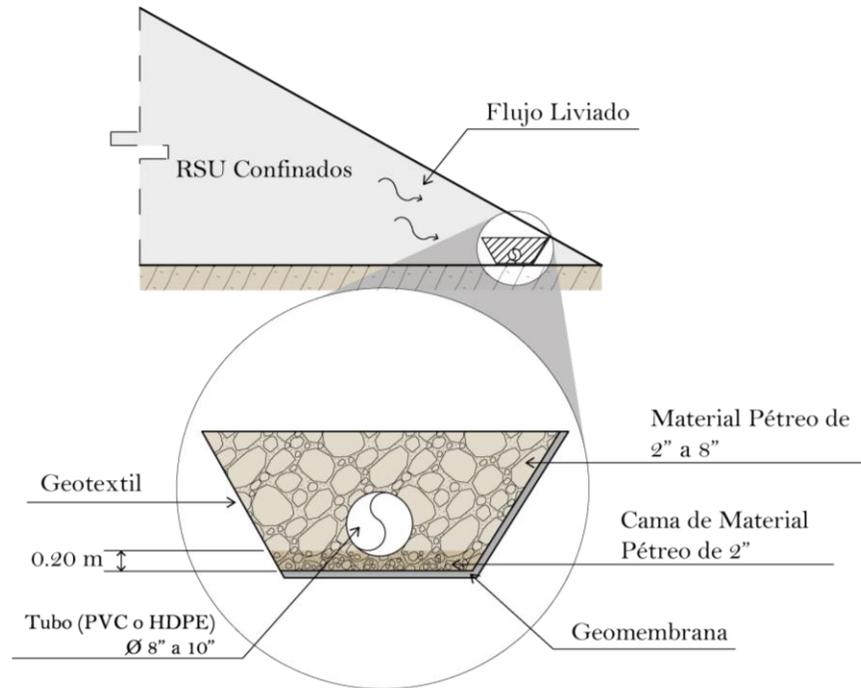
Diagrama de alternativa A de dren perimetral con tubo central y cubierta de geomembrana para la captación de lixiviado a pie de talud
